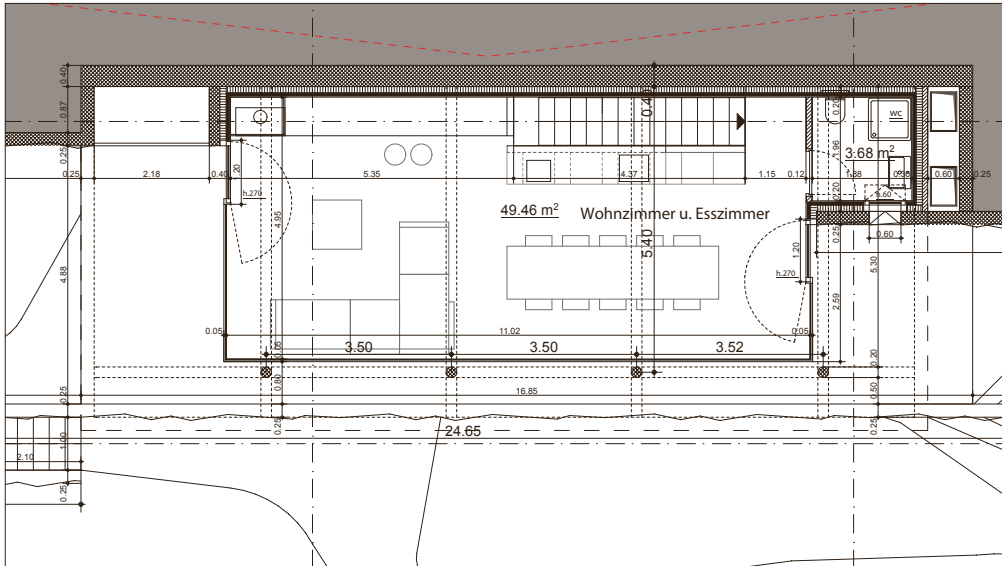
Grundriss Obergeschoss.
